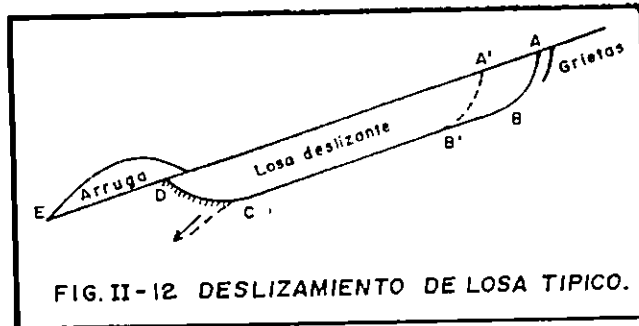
DESLIZAMIENTO DE LOSA TÍPICO.
